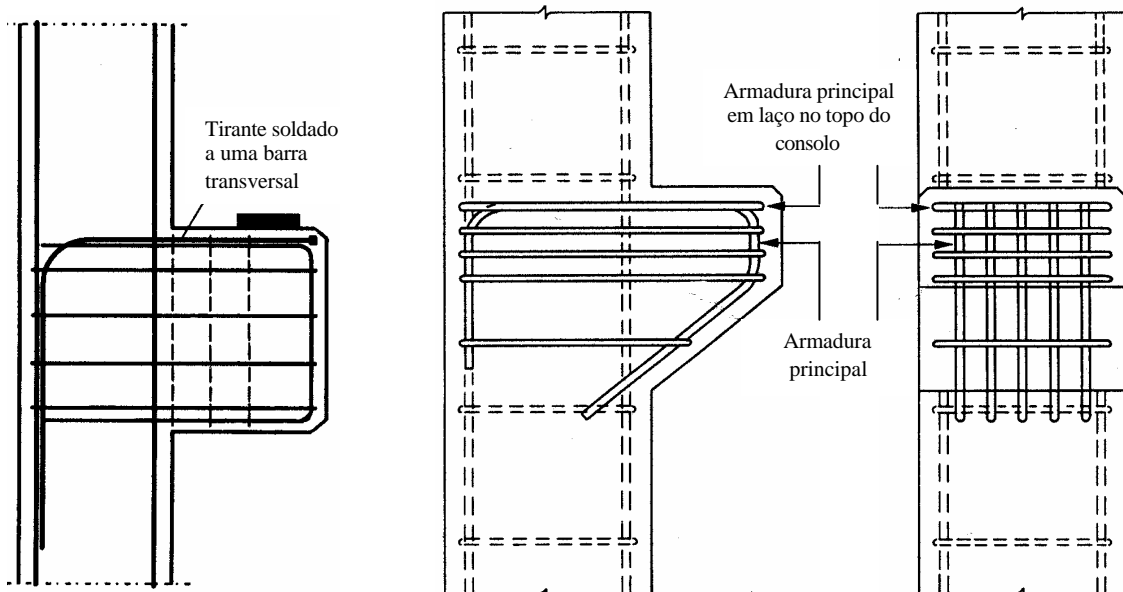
Exemplos de ancoragem para a armadura principal nos consolos
